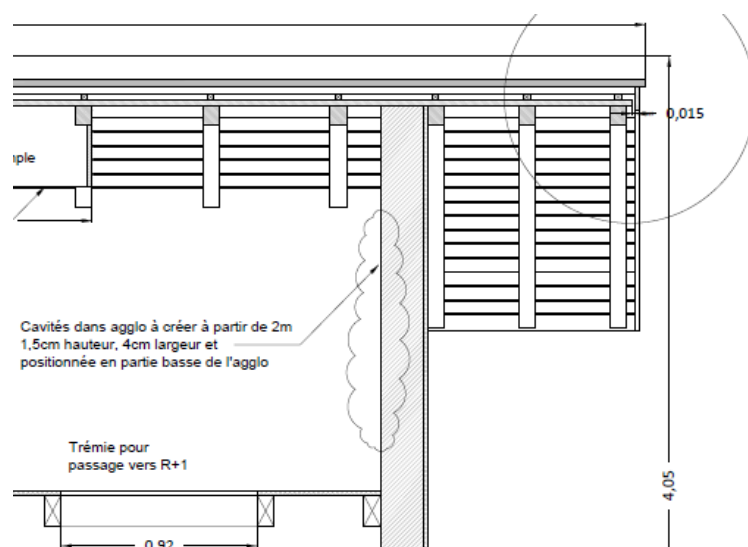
Plan de localisation des cavités accessibles aux Chiroptères dans les agglôs ciment (Source : CD54)
